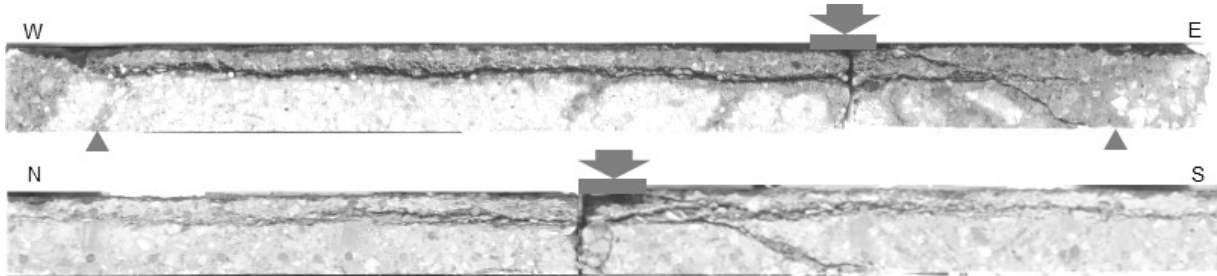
供試体 SF の切断面 (上：橋軸直角 下：橋軸方向)
